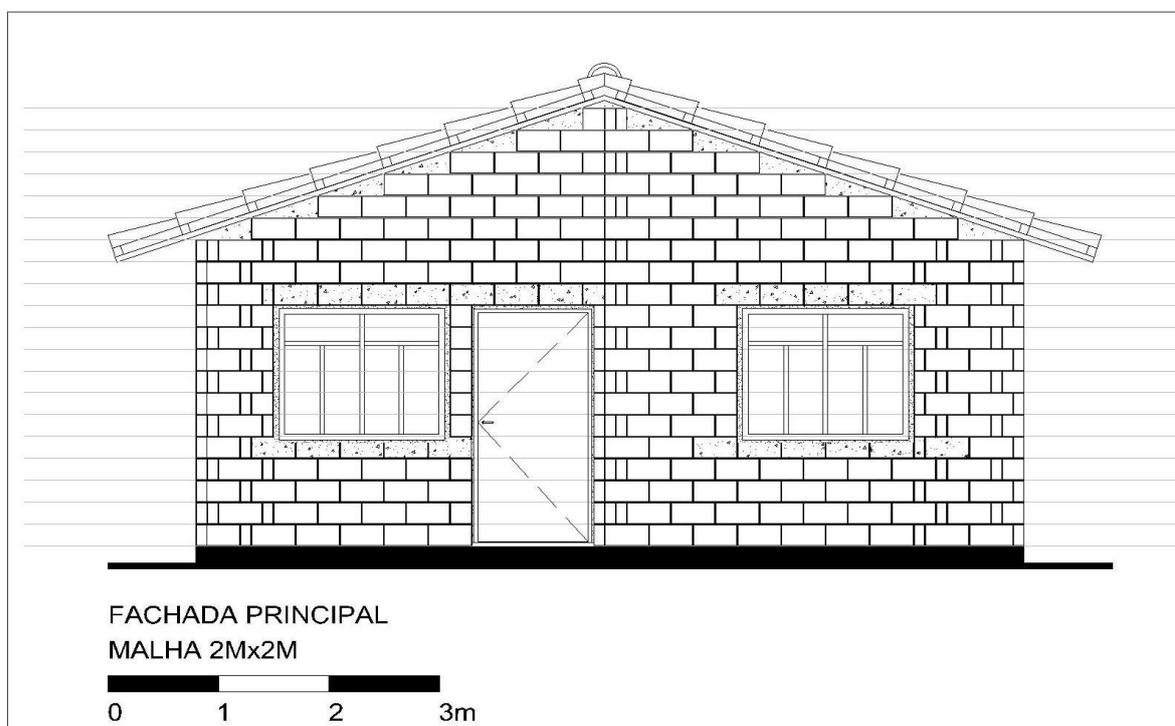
Fachada Principal. Fonte: desenho da autora.
